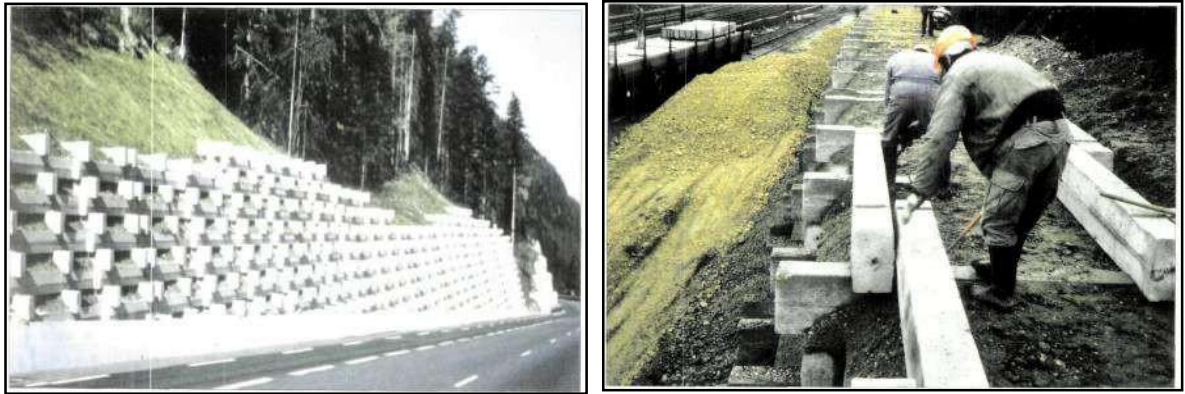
Mur poids constitué de poutres préfabriquées.
